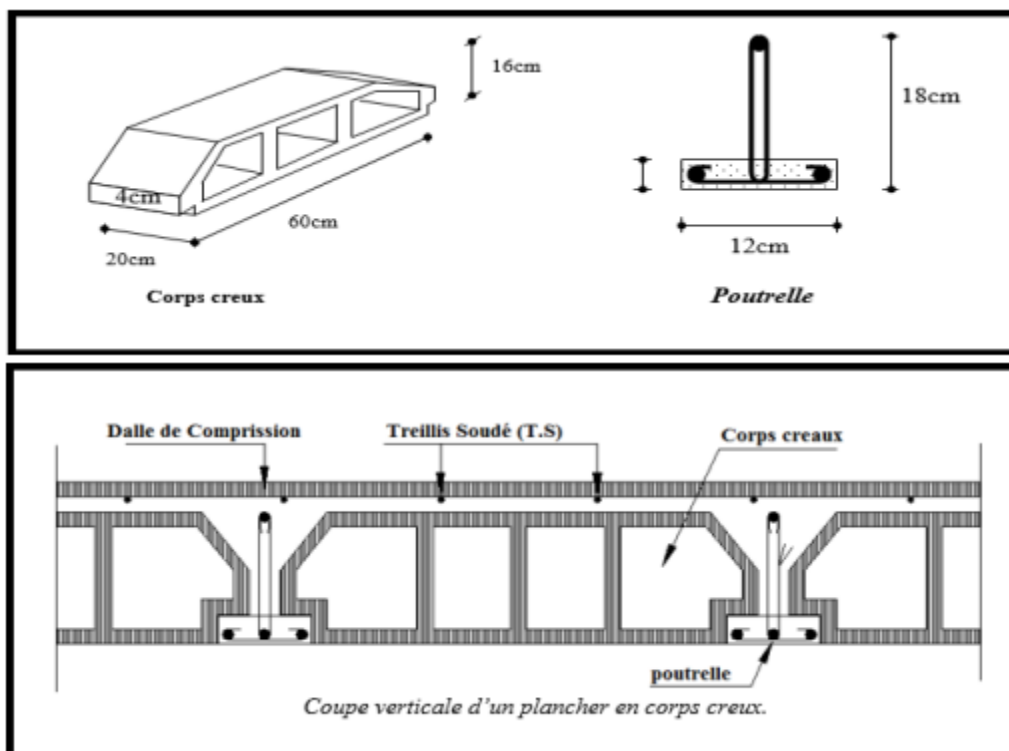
Coupe verticale d'un plancher Corps creux.
